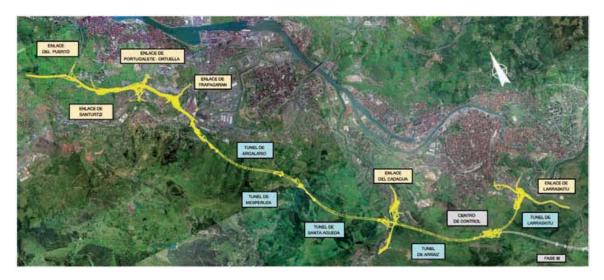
Planta general de la Fase IA de la Variante Sur Metropolitana
